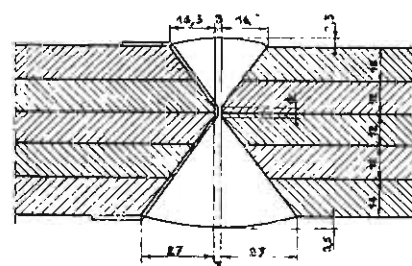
Coupe des cordons de soudure pour les semelles à travers les cornières.
